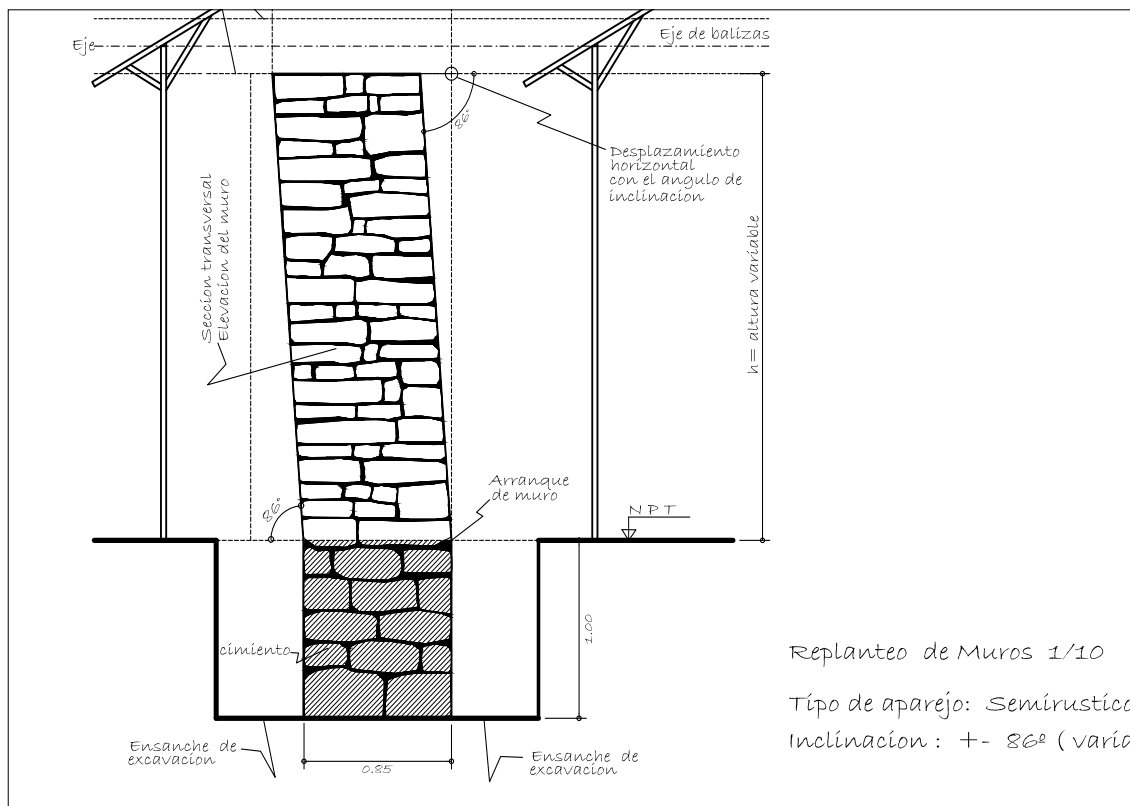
Reconstrucción hipotética de un muro *inka*. Elevación de muro: sección transversal.
